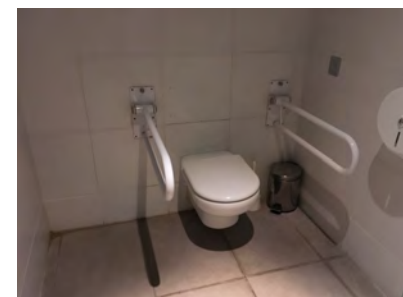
Detalle del inodoro con barras de apoyo en ambos lados
